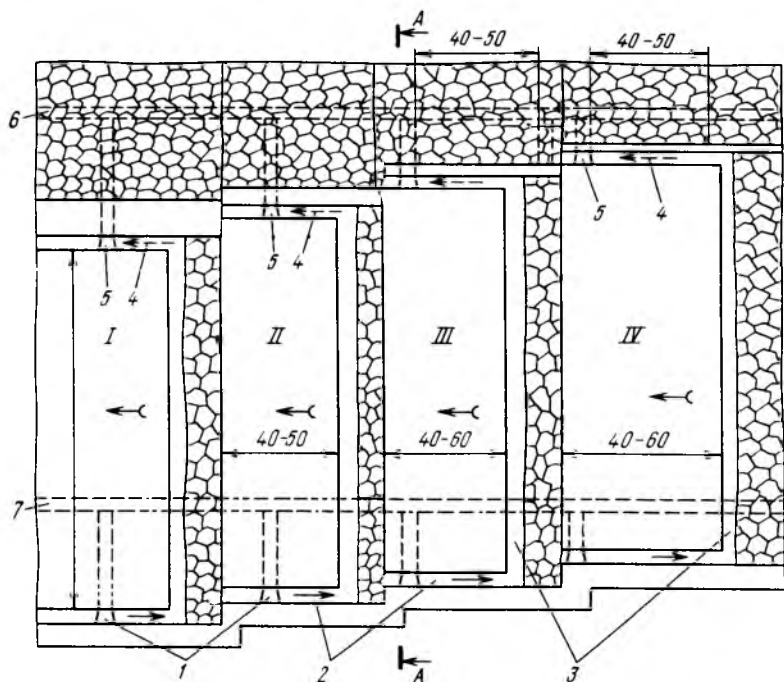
Система разработки мощного пологого пласта наклонными слоями с обрушением кровли:
